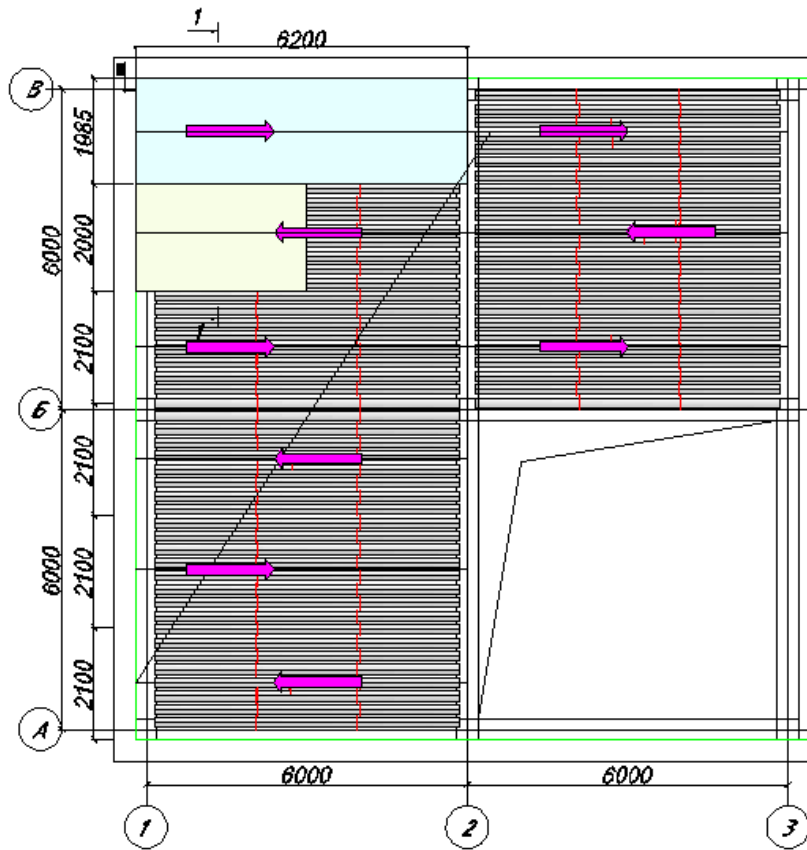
Схема вкладання бетонної суміші для вкладишів-труб
